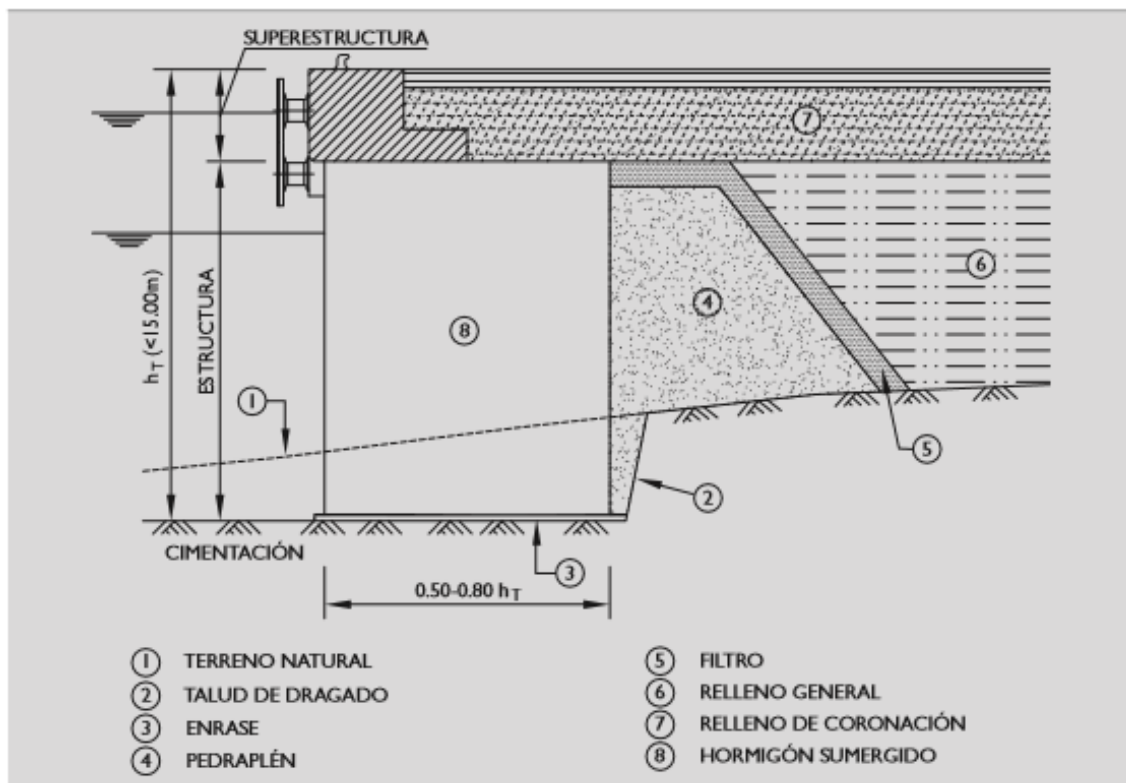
Muelle de hormigón sumergido, sección tipo
